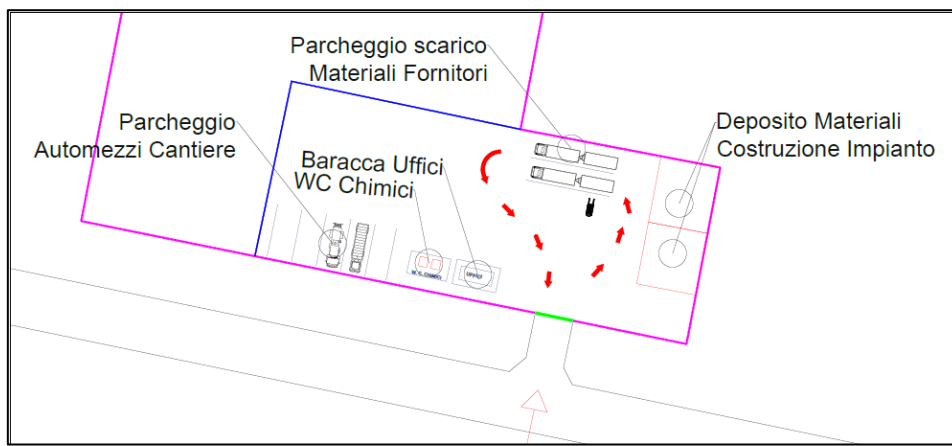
Schema tipo della suddivisione delle aree di cantiere
